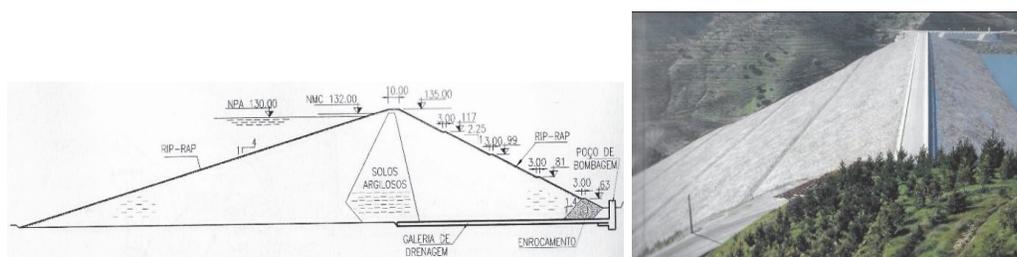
Perfil Transversal e vista da barragem de Santa Clara.
